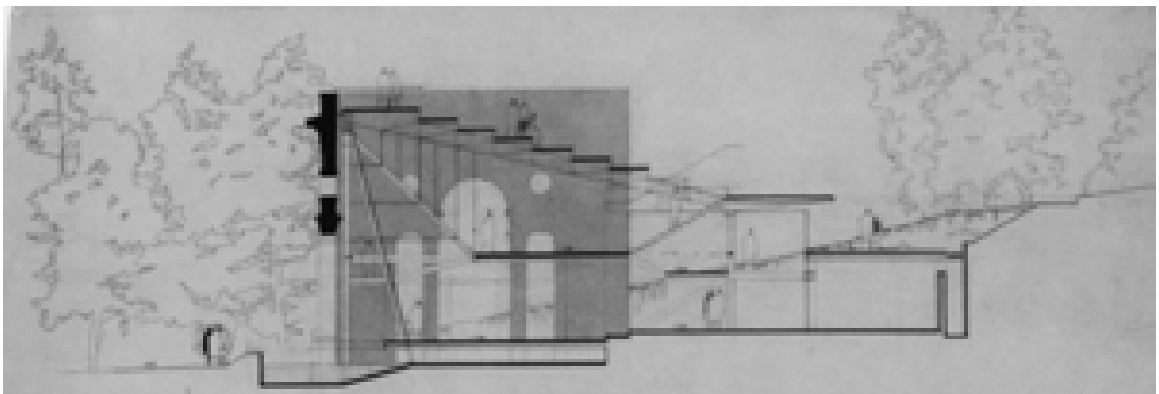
Il progetto di massima, seconda ipotesi (AABS-976)
